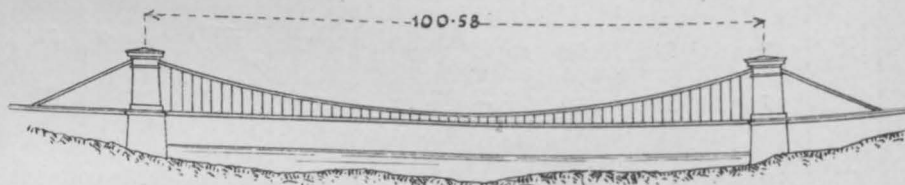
Elbebrücke bei Podiebrad. 1844.
